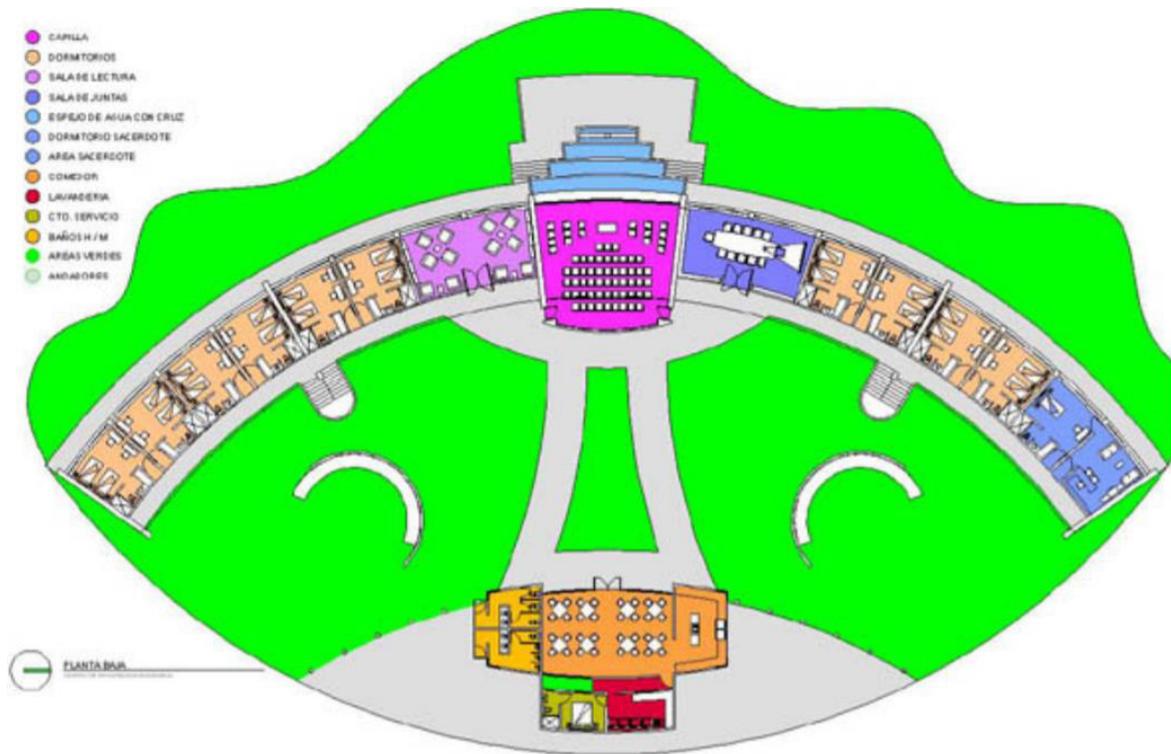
Esquema Arquitectónico planta baja. (Becerra, 2016)
